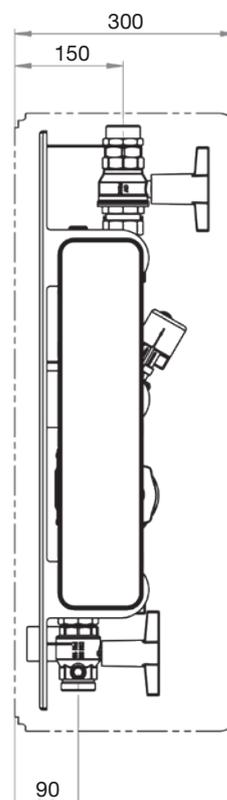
Encombremments «Regumaq X-70» (vue de côté)
